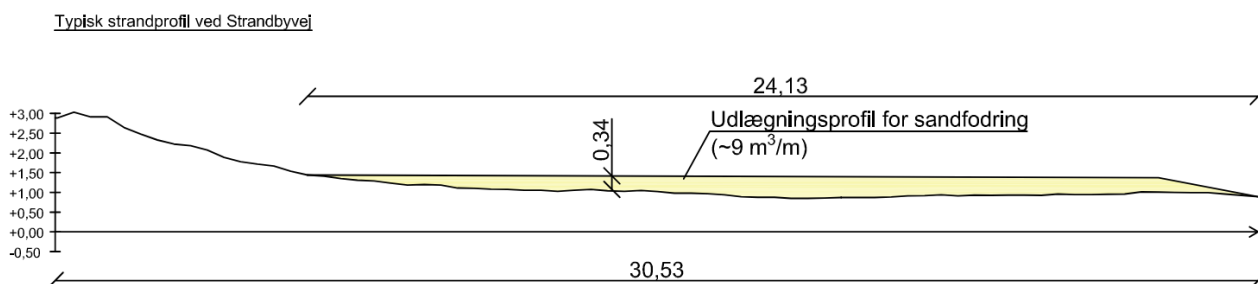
Oversigt af typiske strandprofiler (gul markering) på projektstrækningen.
